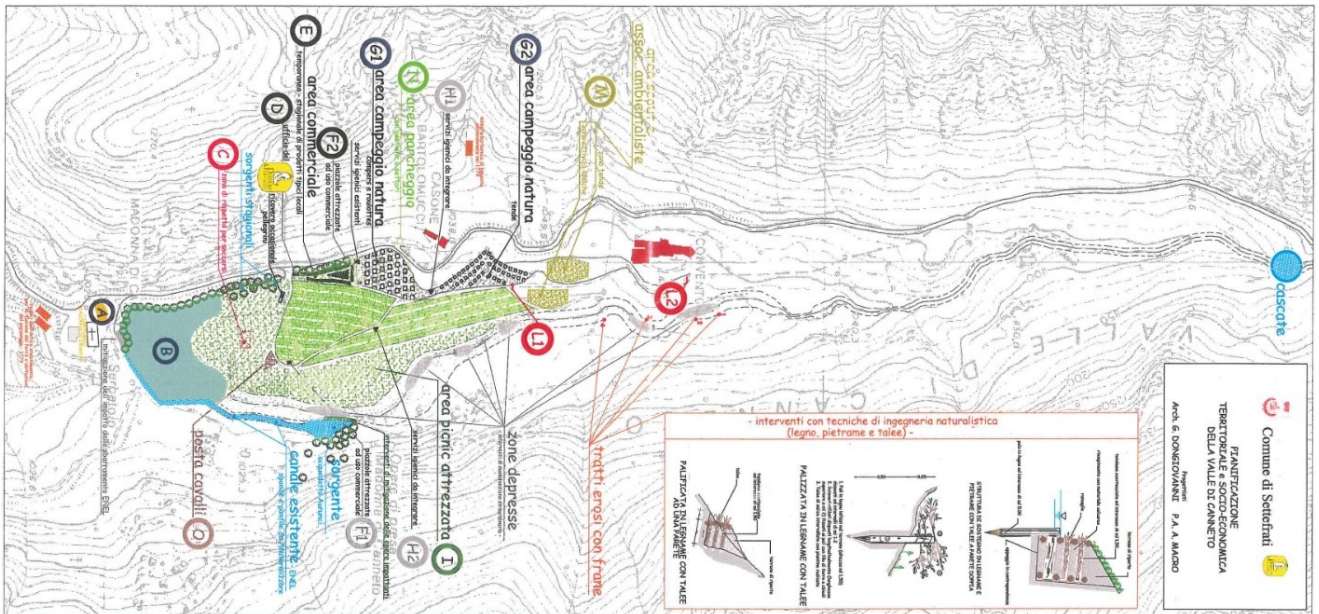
Zona “Valle del Canneto” – Stralcio planimetrico Protocollo d’Intesa
